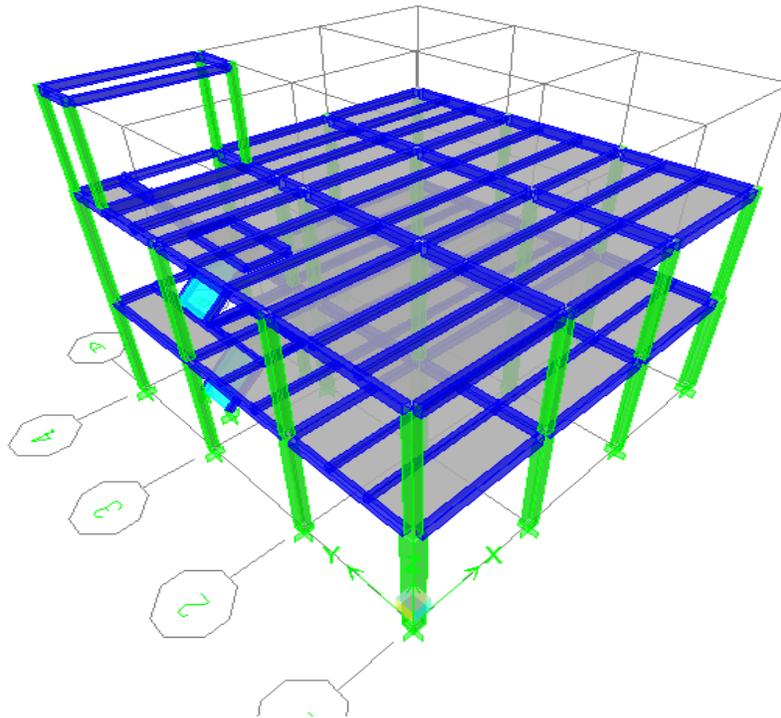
; Modelo tridimensional de la estructura Del diseño estructural metálico
